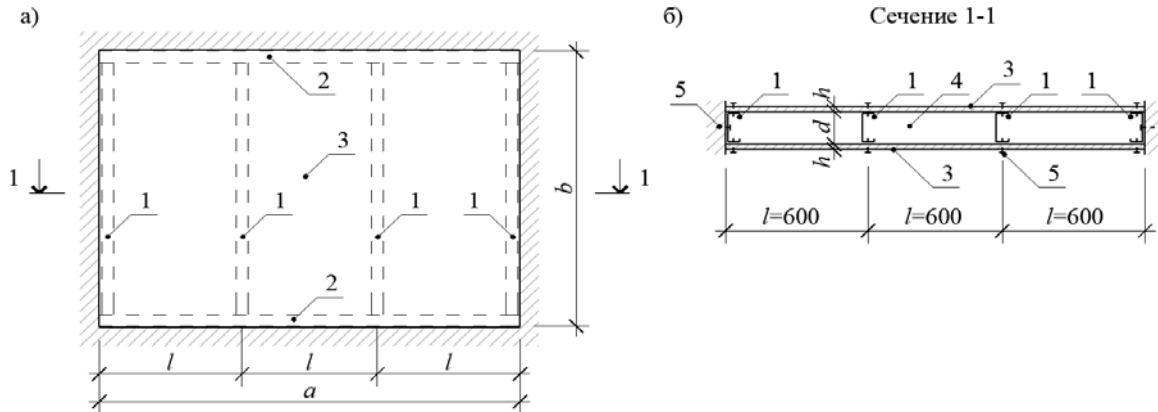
Конструктивная схема каркасно-обшивной перегородки с одинарным каркасом: а) вид спереди; б) план (горизонтальное сечение); 1 – вертикальные стоечные профили каркаса; 2 – горизонтальные направляющие профили каркаса; 3 – наружные обшивки; 4 – воздушный промежуток без заполнения звукопоглощающим материалом или с заполнением; 5 – винты-саморезы для обеспечения крепления обшивок к профилям каркаса (шаг – 250 мм);  $a$  – длина перегородки;  $b$  – высота перегородки;  $l = 600$  мм – шаг установки вертикальных стоечных профилей каркаса;  $h$  – толщина обшивок;  $d$  – ширина воздушного промежутка между обшивками
